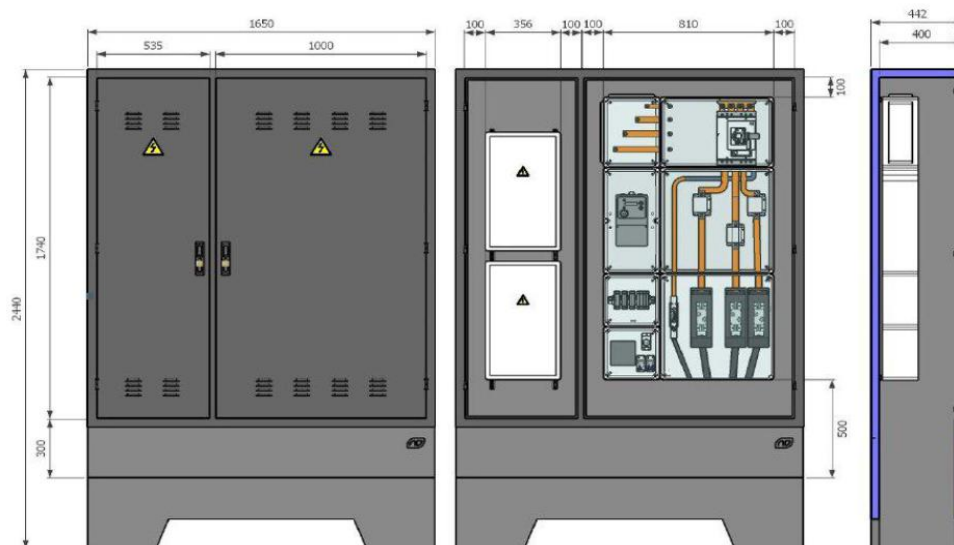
Detall armari prefabricat instal·lació d'enllaç
